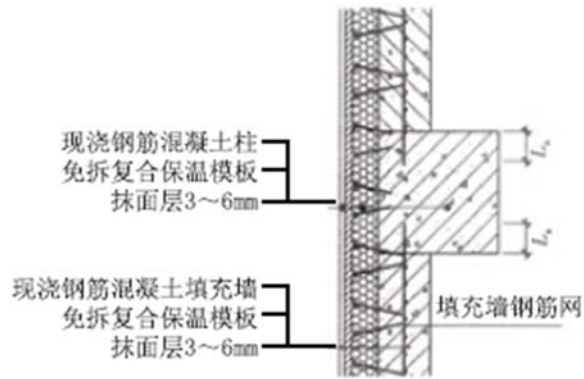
薄防护层免拆复合保温模板与混凝土构件相接部位构造做法
